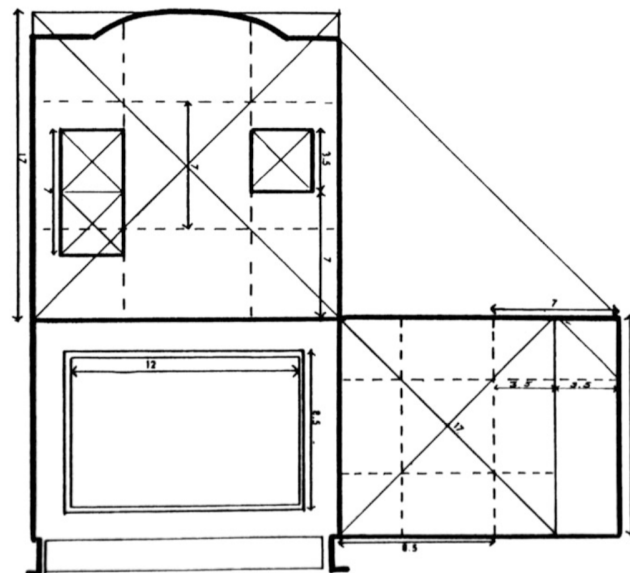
análises de proporções em alçado da Casa da coluna toscana.
